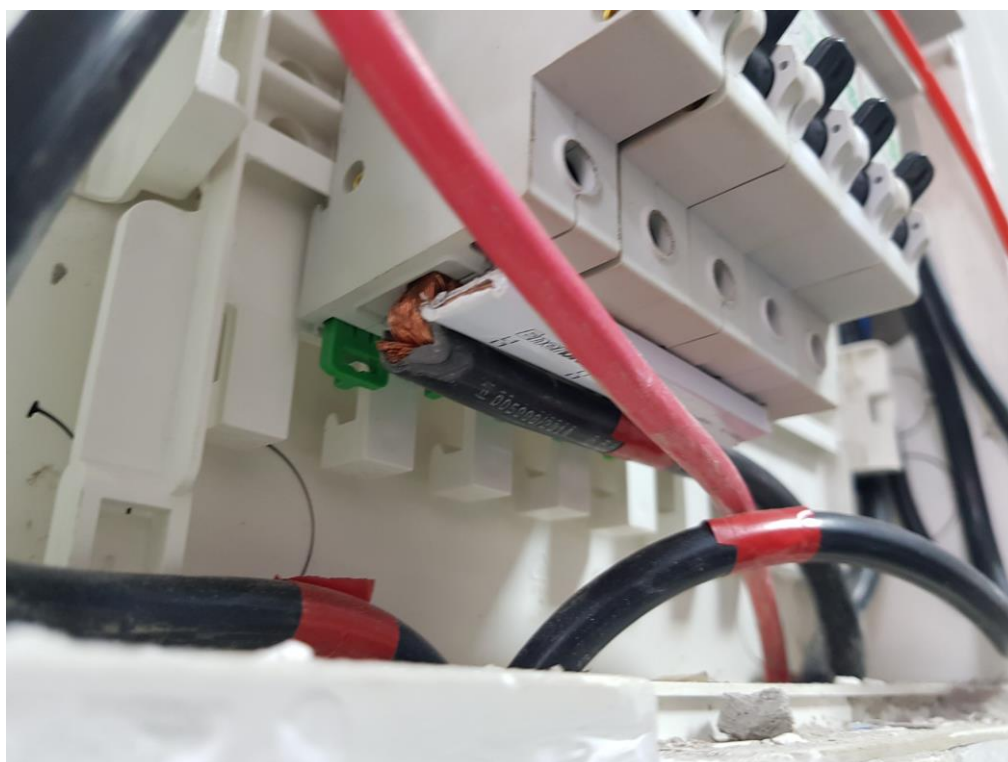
Cabo cortado pela metade, risco de choques – Fonte Autor
